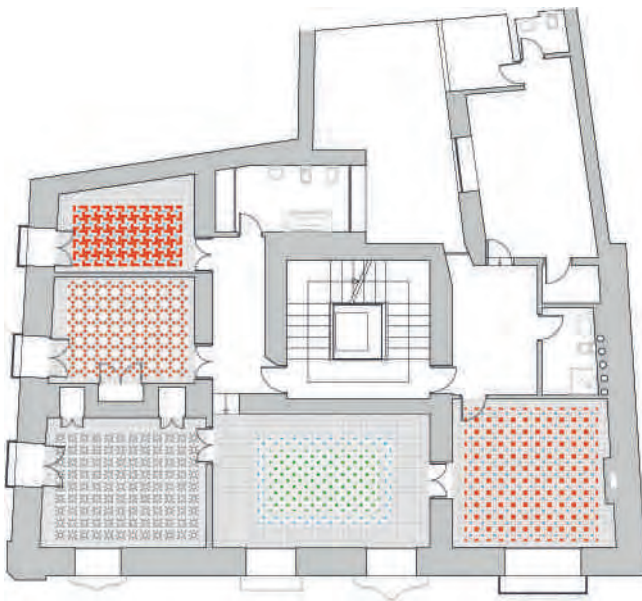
Plano de planta donde se muestran algunos de los solados de baldosa hidráulica que se han recuperado. Juan de Dios de la Hoz, Lavilla Arquitectos.
